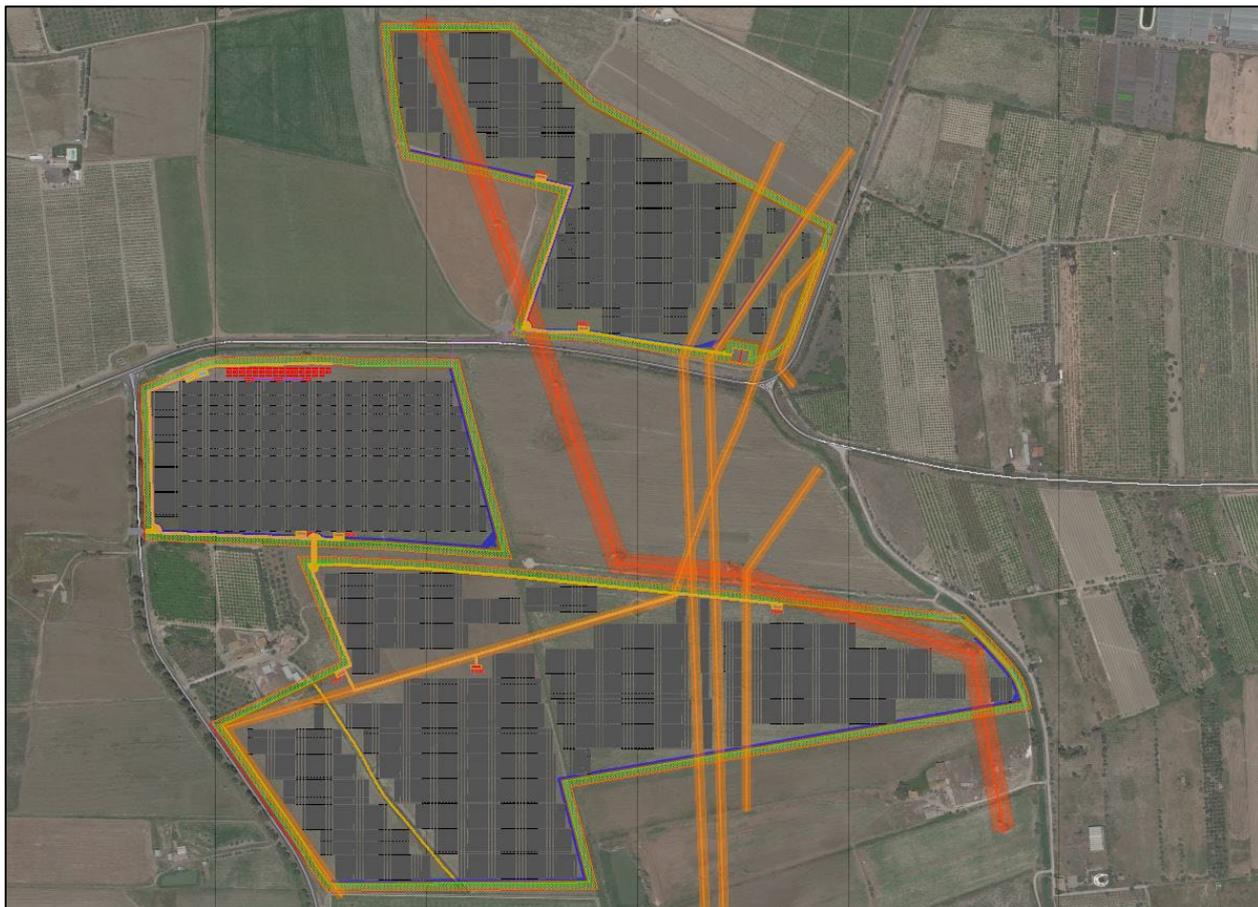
Layout dell'impianto completo su ortofoto.
